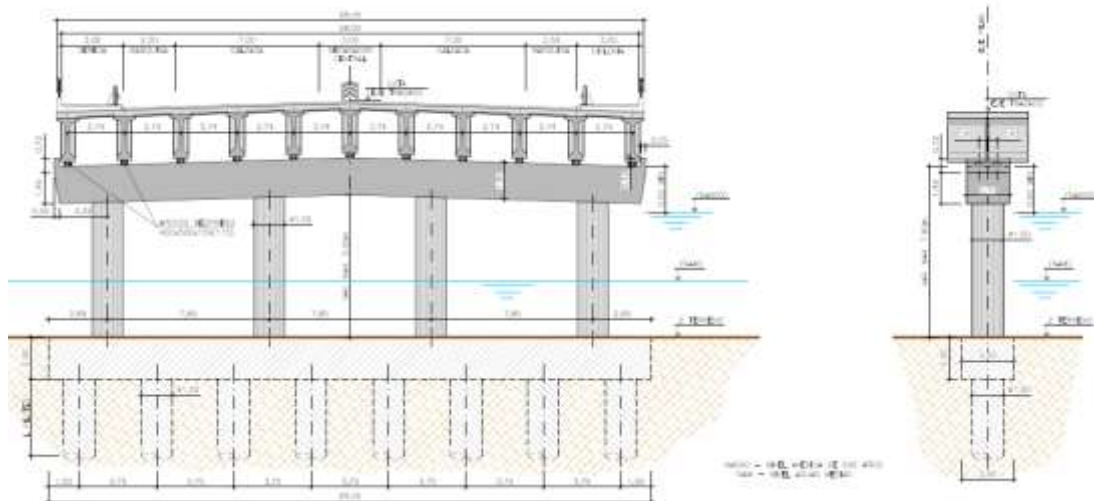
Pila pórtico Tipo 1, para apoyo de tablero de calzada doble.
